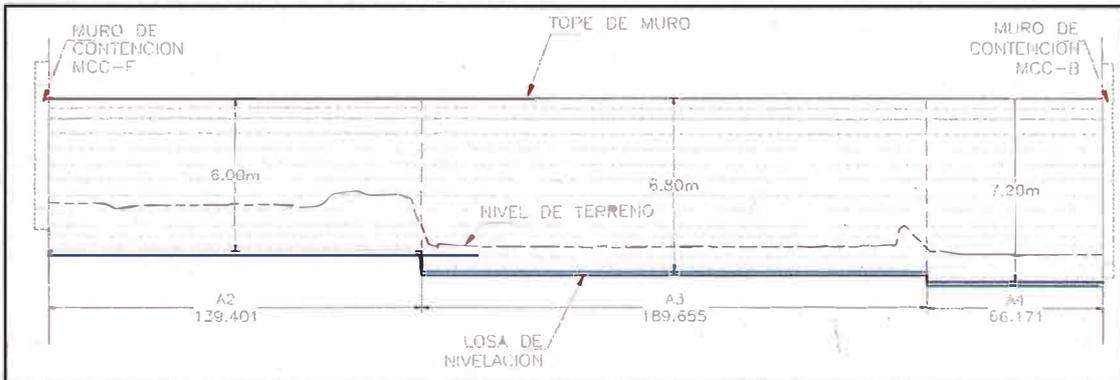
Patio de Maniobras – Elevación de muro de suelo reforzado.
